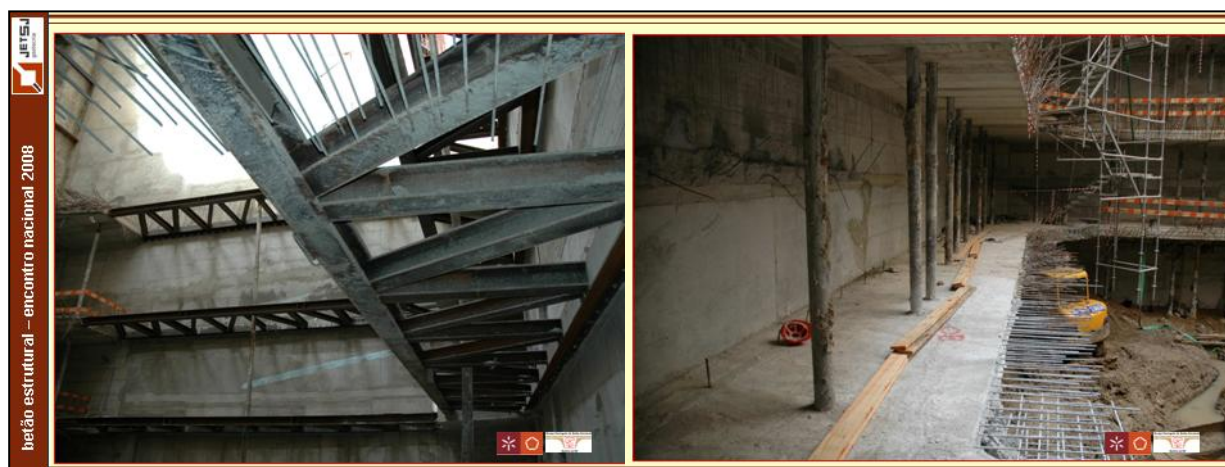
Vista dos travamentos conferidos pelas vigas treliçadas metálicas e pelas bandas de laje.
